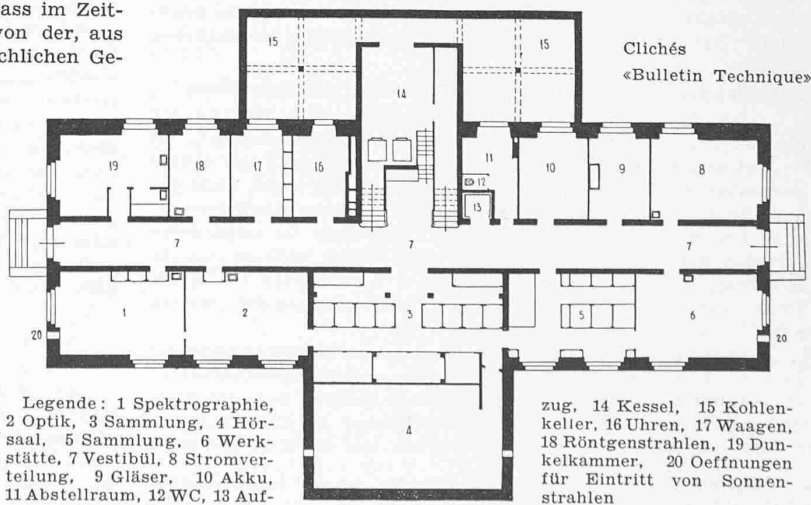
Grundriss vom Untergeschoss des Uhren-Laboratoriums Neuenburg. — 1:400
